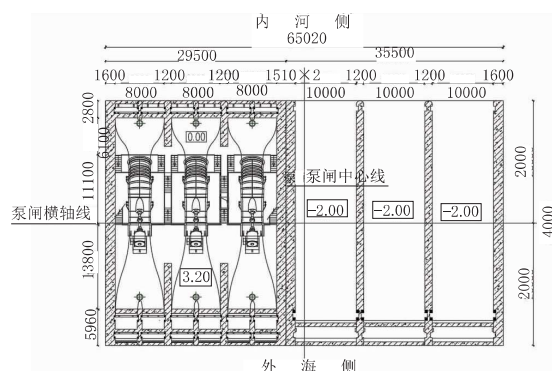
张泾河泵闸主体结构平面布置图(单位:mm)
